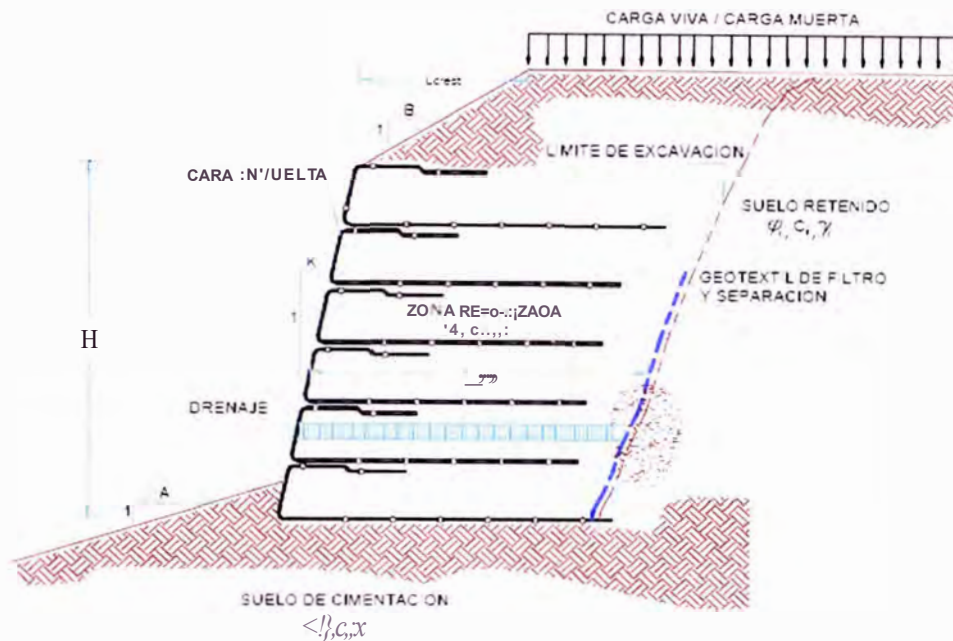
Sección Típica de un Muro de Suelo Reforzado con Geotextil
